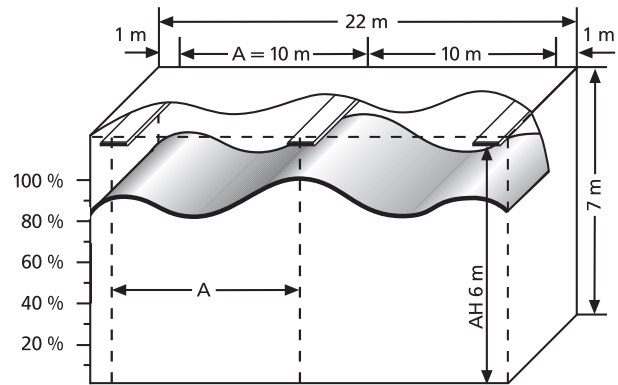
d Gleichmäßig verteilte Deckenstrahlflächen mit $A > AH$
